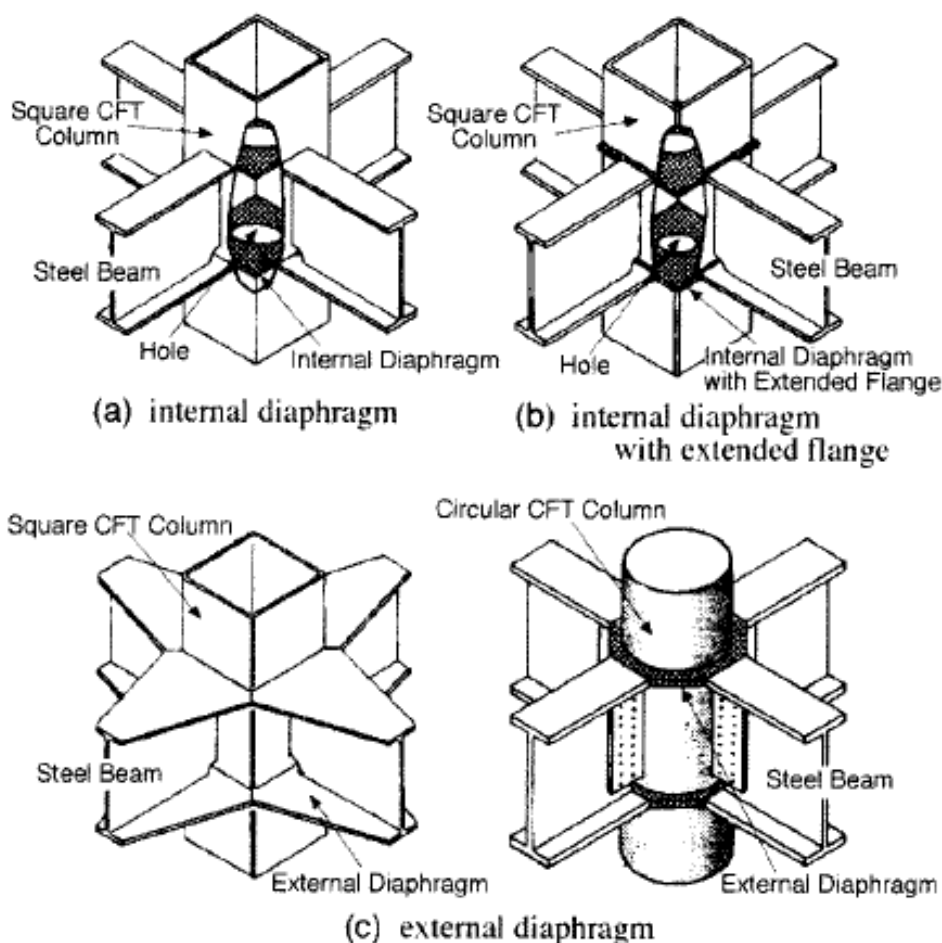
Detalles convencionales de conexión viga –columna CFT de acero [18]
